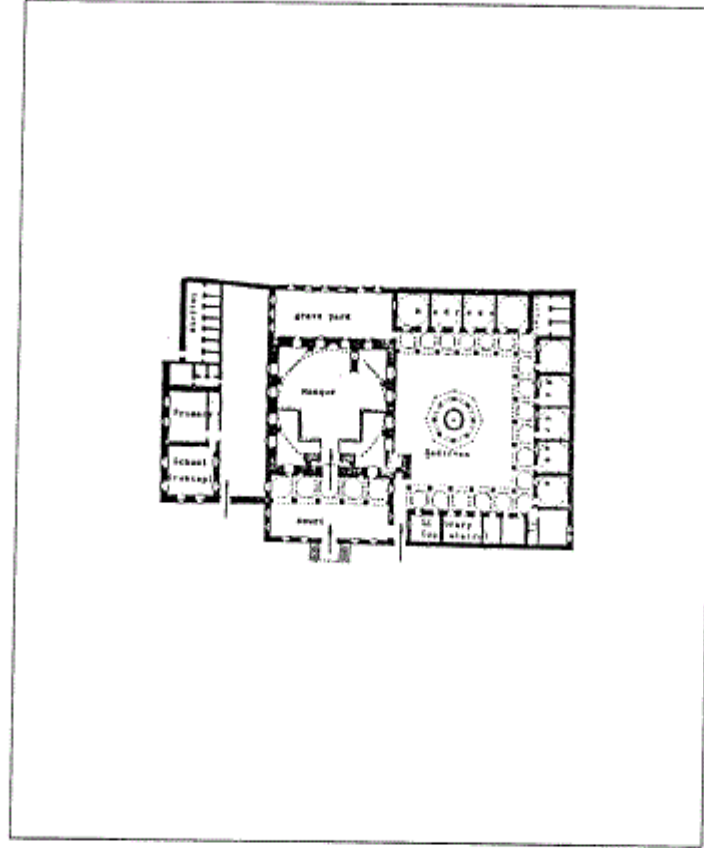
مسقط أفقي لمسجد نور عثمانية في إسطنبول (عن : جودوين) .
